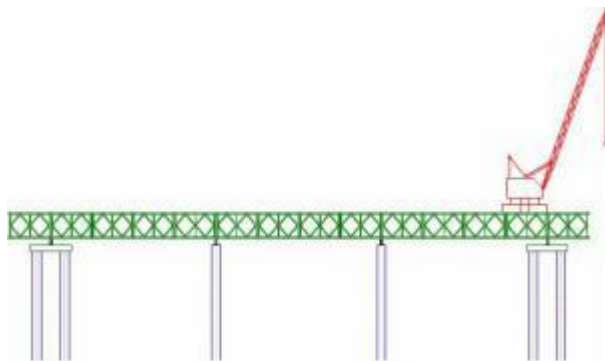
施工栈桥“钓鱼法”施工示意图
